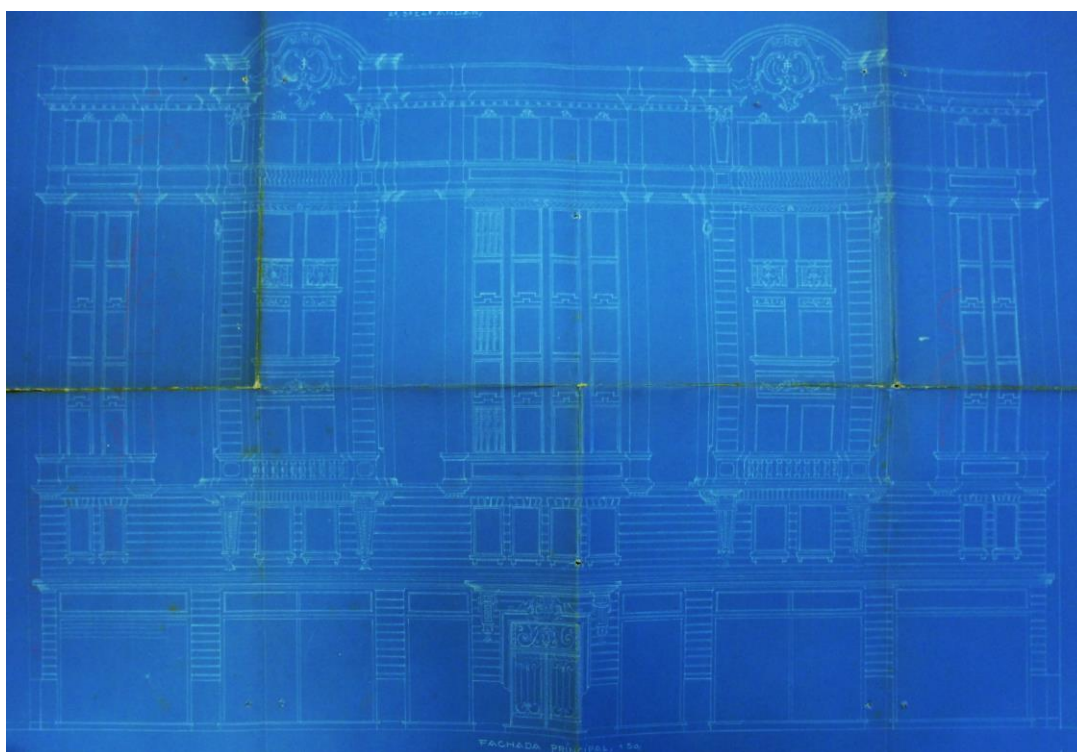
Desenhos da Fachada Palacete Paraíso.
